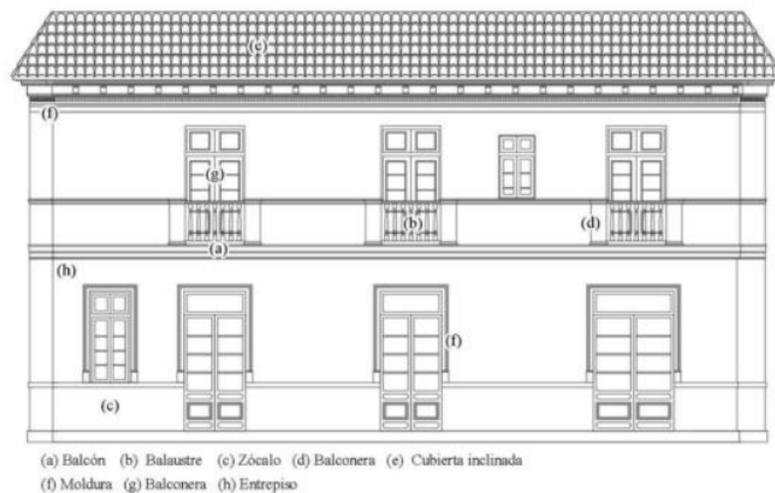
Identificación de elementos en fachadas de las viviendas Vernáculas.
